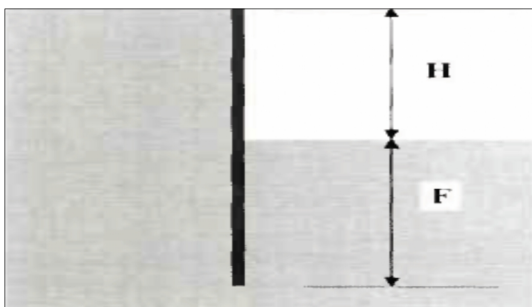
Dimensionnement courant d'un mur en béton armé.
